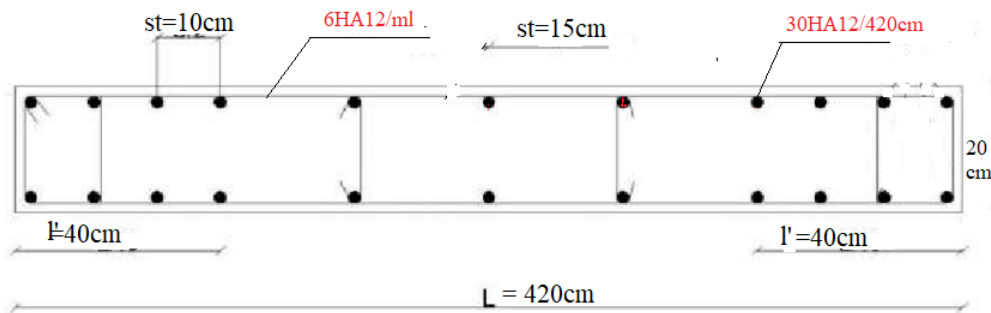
Coupe longitudinale du ferrailage des voiles (3<sup>ème</sup> au 9<sup>ème</sup> étage)
